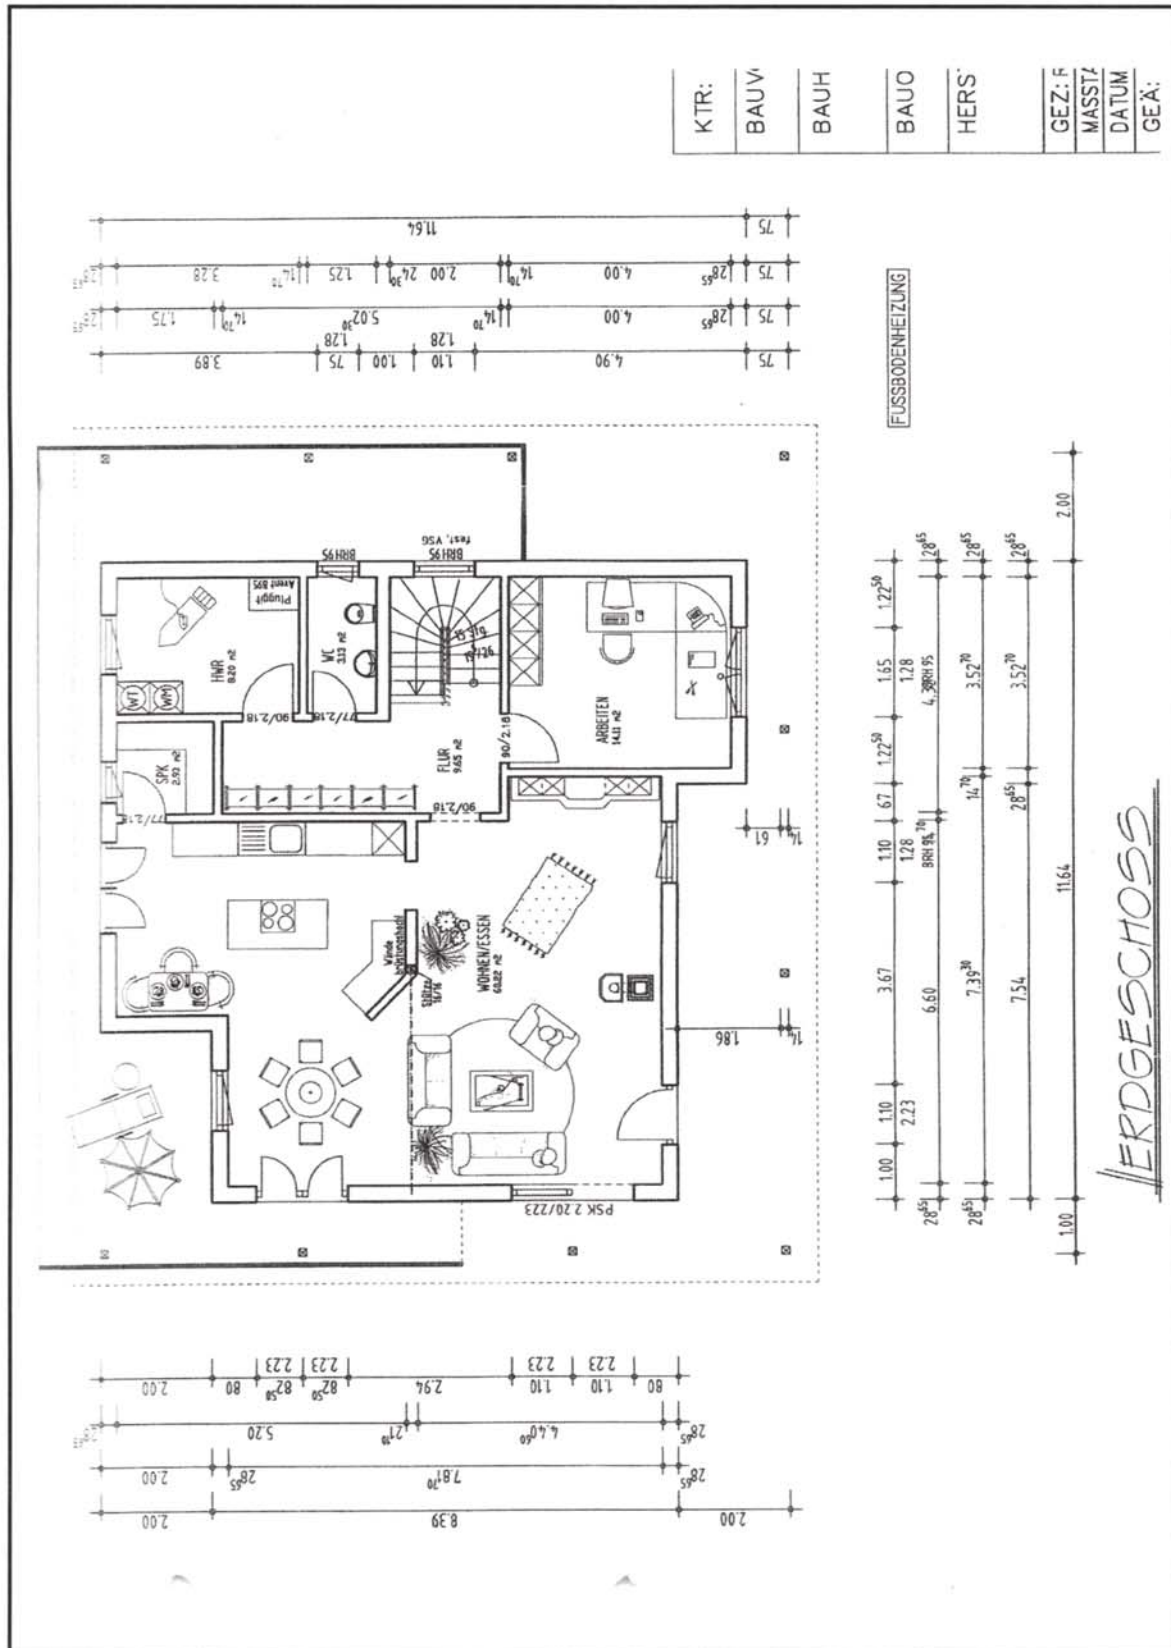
Grundrissplan (eingescannt)
